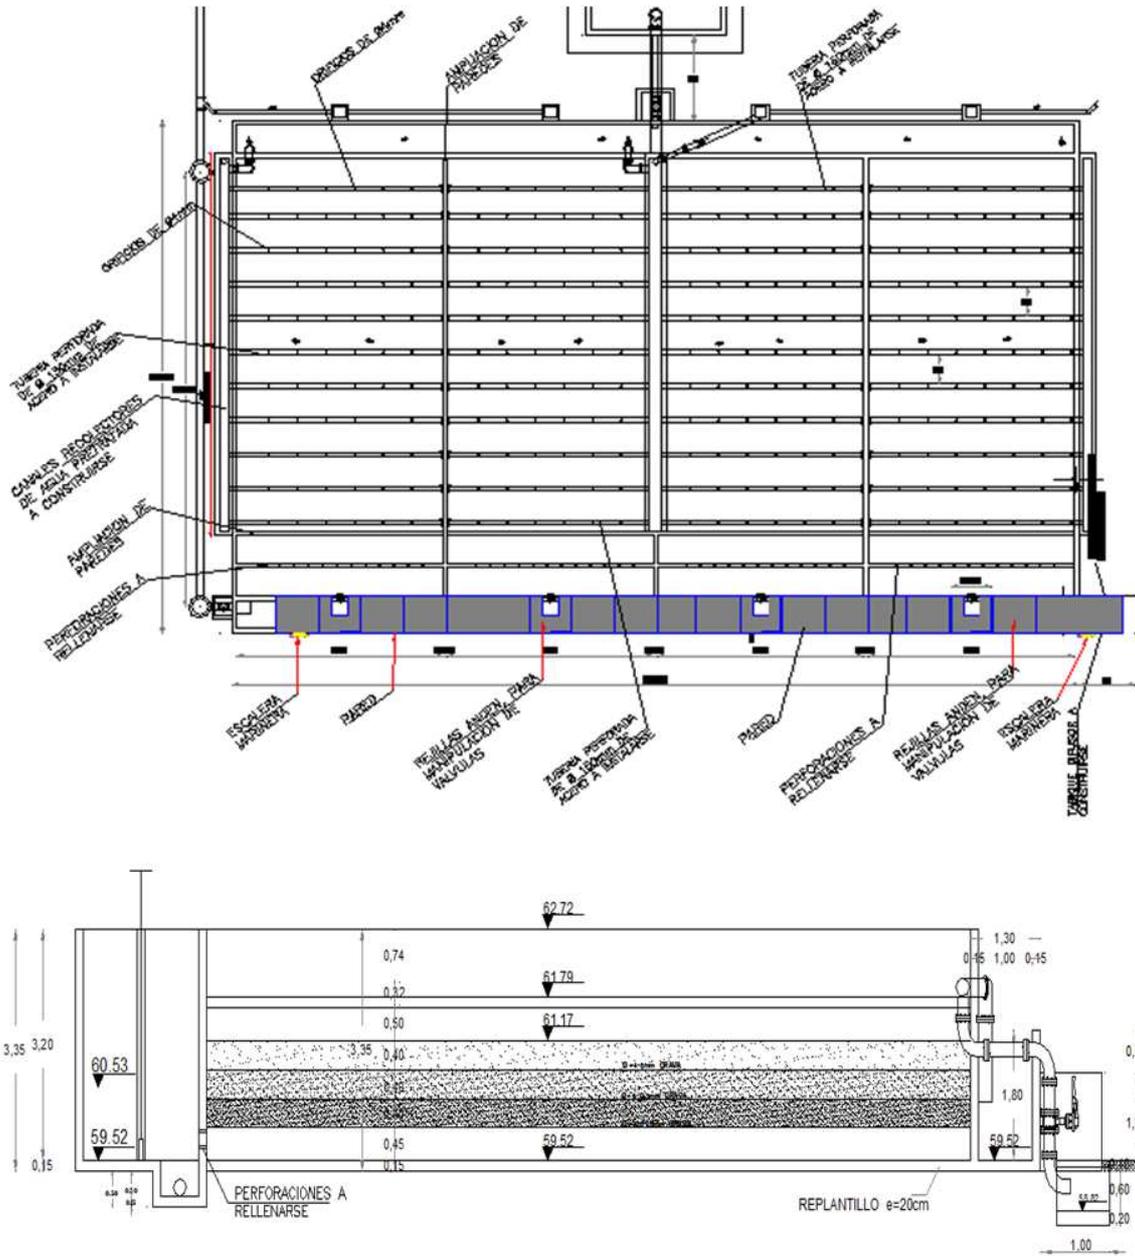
Filtros Gruesos Dinámicos existentes (Planta y Corte)
